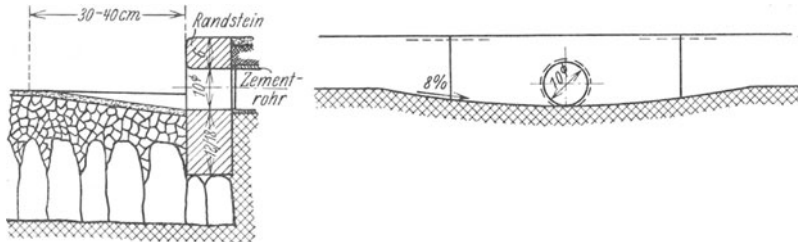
Abführung des Regenwassers unter dem Gehweg.
